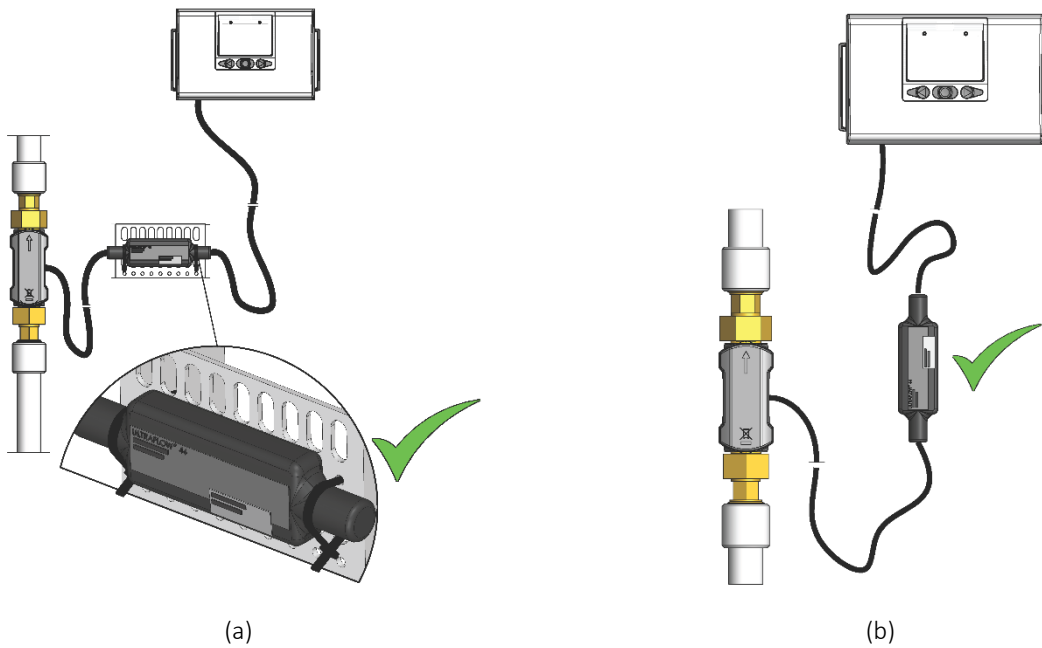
Монтаж ULTRAFLOW® 44 в восходящей трубе. (а) Во влажном окружении блок электроники устанавливается горизонтально с помощью кабельных стяжек, а вычислитель монтируется на стену. Провода/кабели должны свободно провисать вниз с мест присоединения для стекания с них воды и конденсата. (б) Блок электроники свободно свисает.
